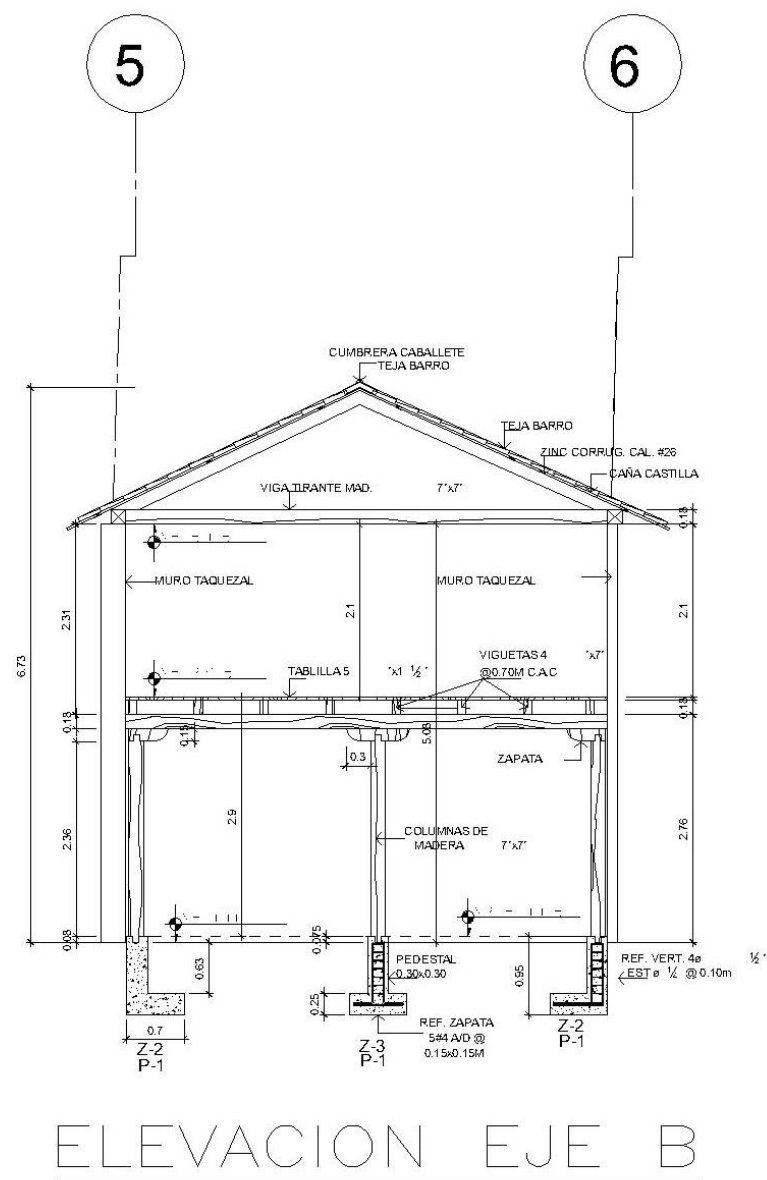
Elevación Estructural B de Habitación 1 y Mezzanine. Jardín.
